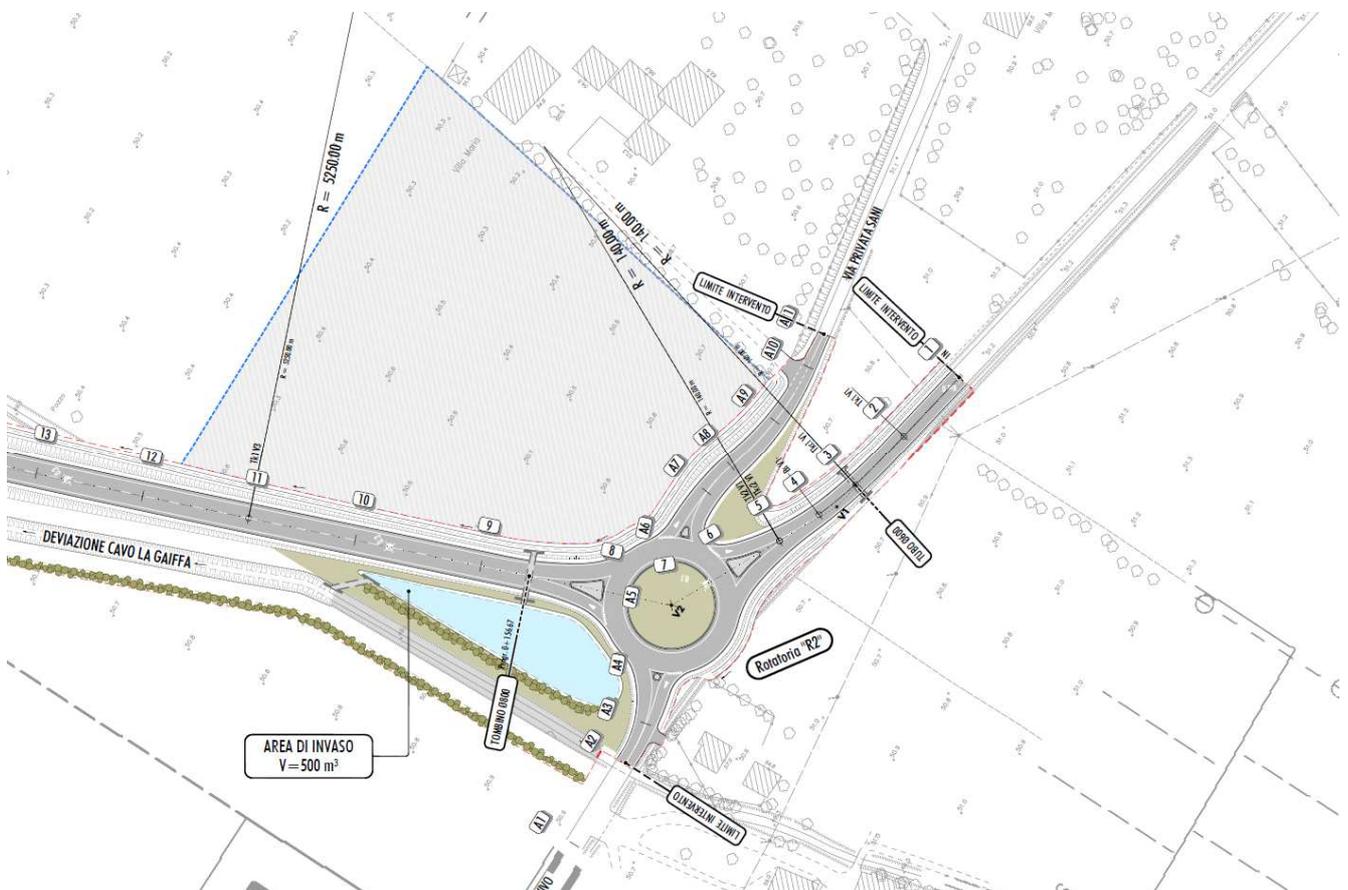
STRALCIO PLANIMETRICO ROTATORIA "R2" SP11 DI BUSSETO – VIA PRIVATA SANI
